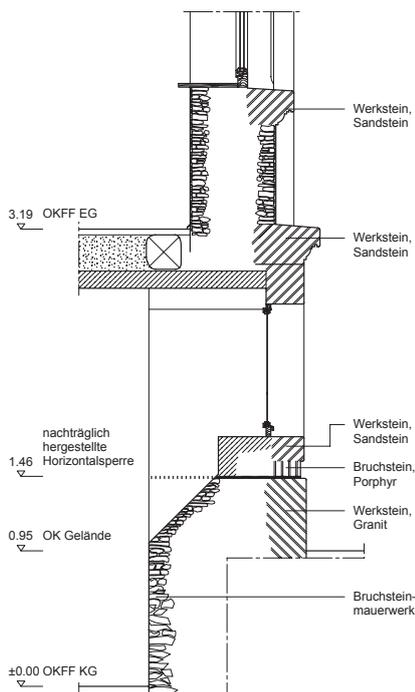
Neu erstellter Vertikalschnitt Keller-Fassade EG
